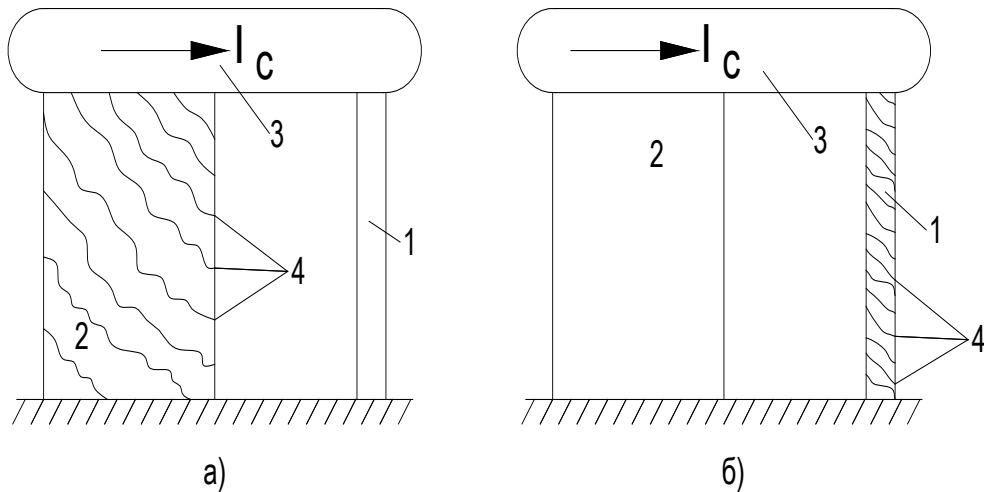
Расчетная схема типового этажа здания с гибким каркасом и жесткой диафрагмой:
